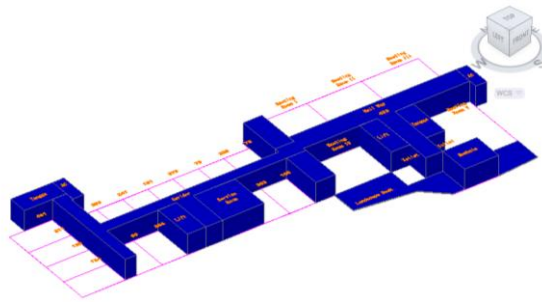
Tampilan 3D Lantai 6 (Marketing 5) *Best Western STAR Hotel and Apartment
